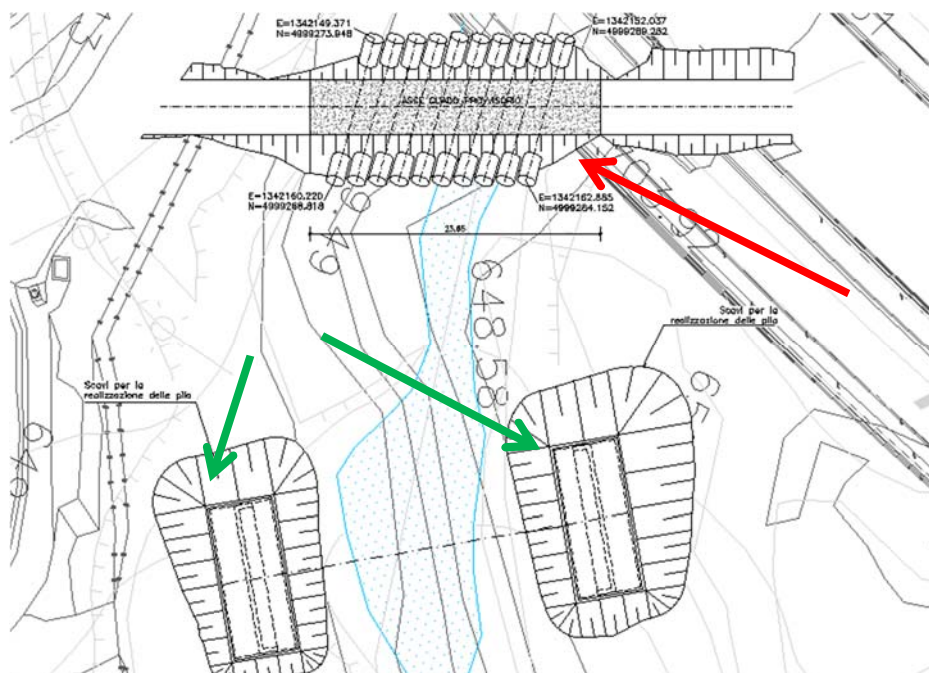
Guado provvisorio indicato con freccia rossa. Con freccia verde sono indicati gli scavi per la realizzazione delle spalle del Ponte Bailey
